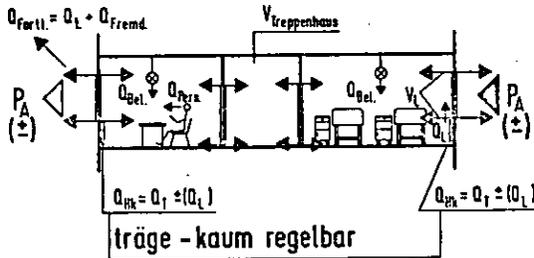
Schema einer Geschoßdurchlüftung Bettzimmer/Flur/Betriebsraum, oder umgekehrt je nach Druck P_A
